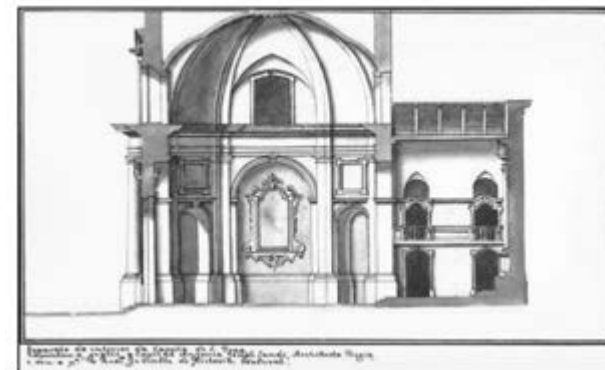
Fachada lateral da Capela de São João Batista. Fonte: Fórum Landi (2007).
